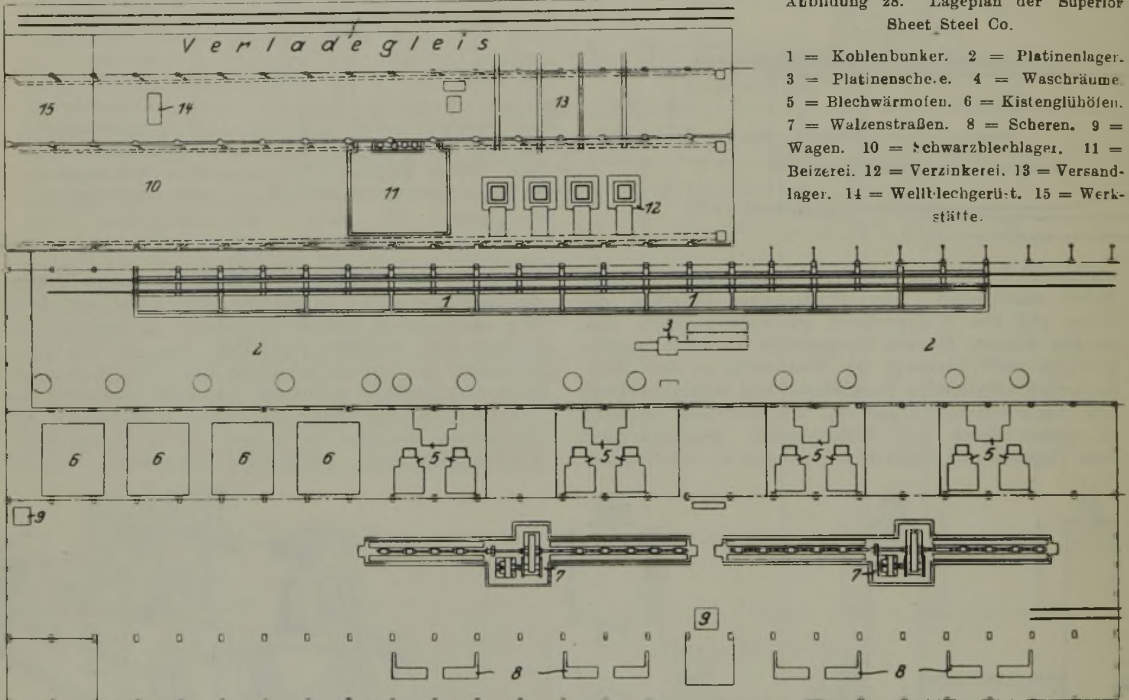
Lageplan der Superior Sheet Steel Co.
